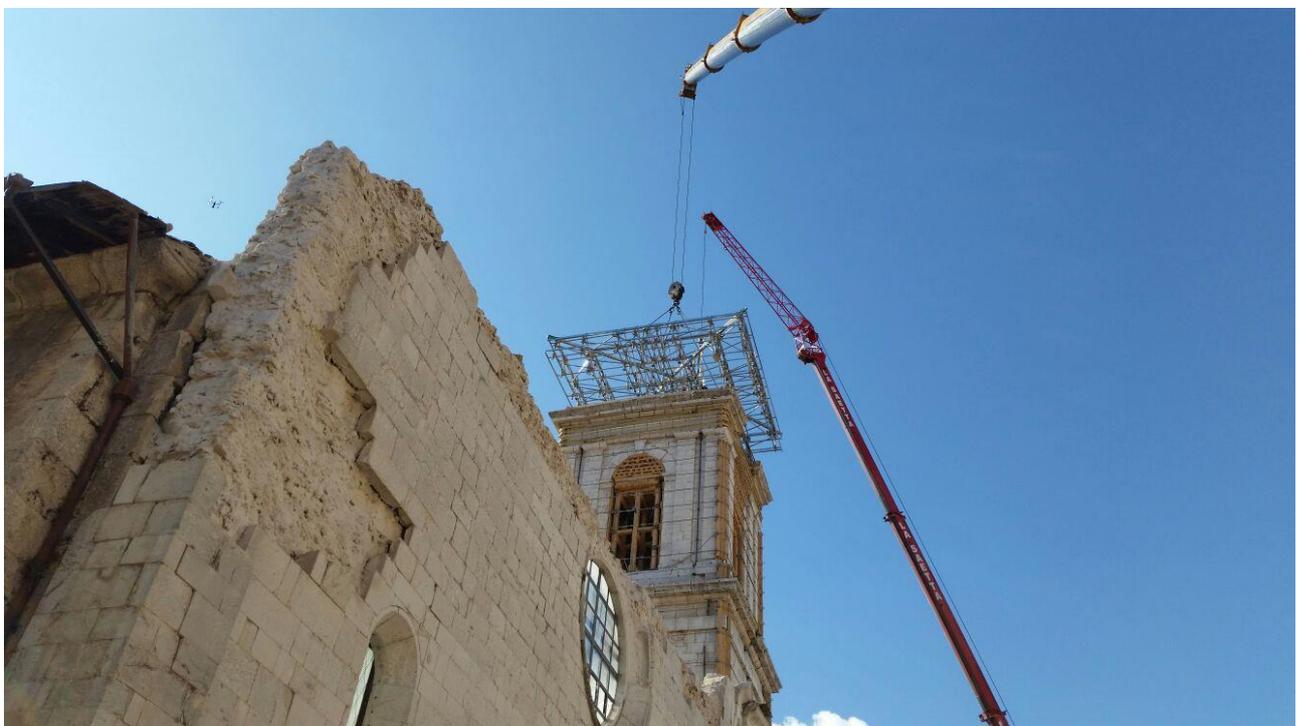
Concattedrale di Santa Maria Argentea a Norcia, la posa in opera della struttura della messa in sicurezza della torre campanaria, (Foto dell'autore).
